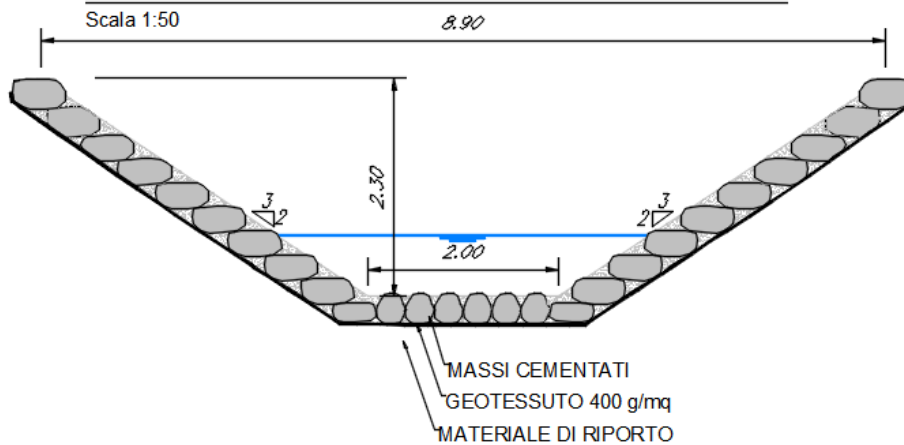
Corso d'acqua IN04_ Sezione tipo sistemazione
